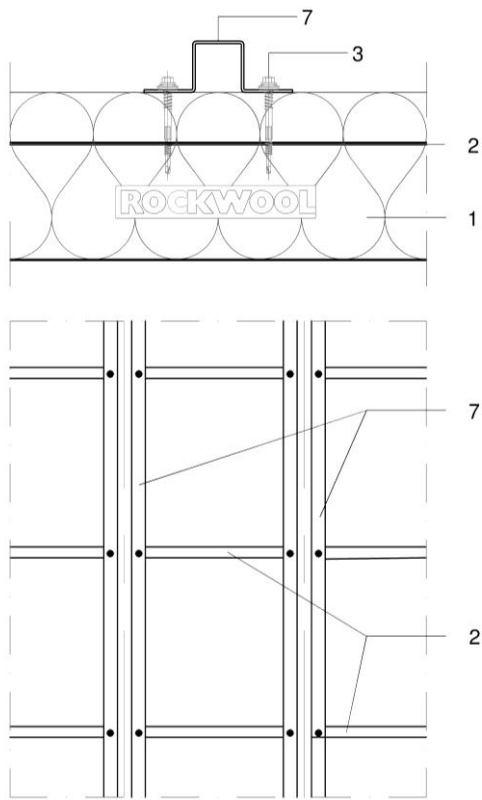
Sección horizontal. Bandejas en posición vertical. Hoja exterior sin subestructura intermedia.
